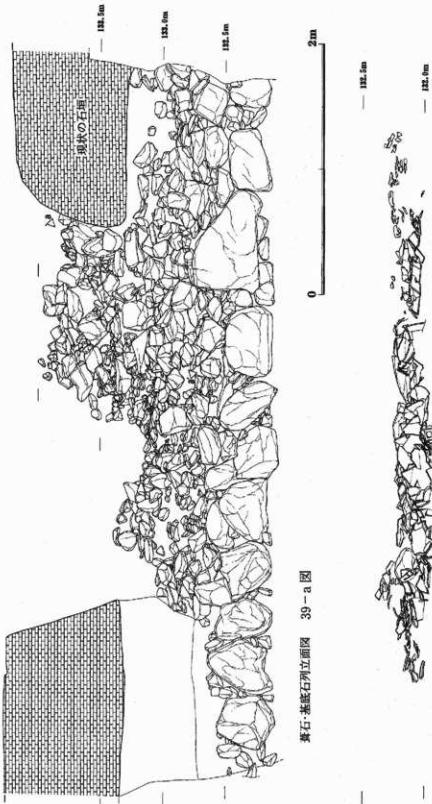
北侧厂区 I区基础部立面图 (S = 1/30)
